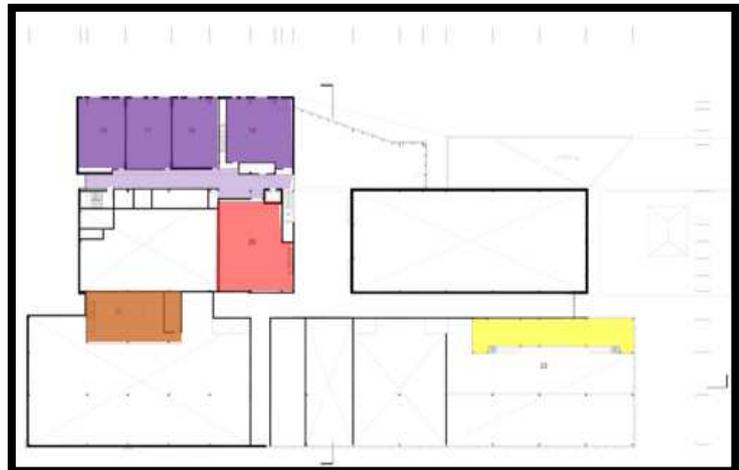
vue en plan du premier étage de centre MINTO source : www.archdaily.com traité par l'auteur
